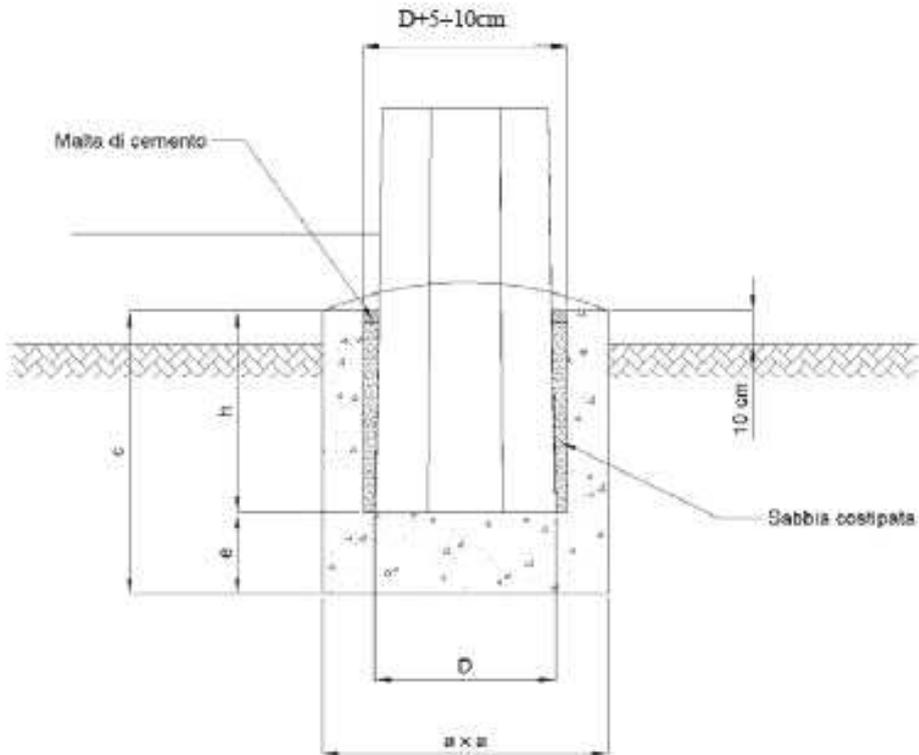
configurazione tipo e dimensioni del basamento di fondazione
